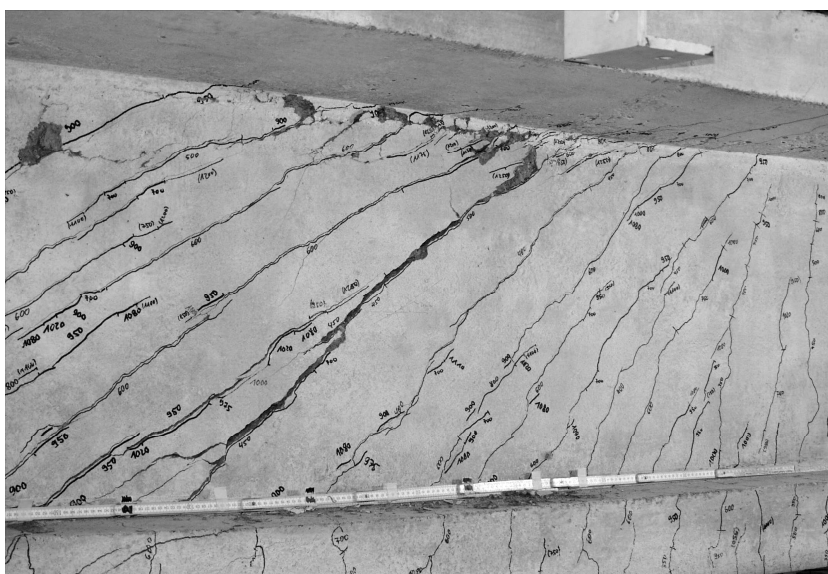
Bruchbild des Trägers 1: Betonabplatzungen im oberen Bereich des Steges und maßgebender Schubriss.
